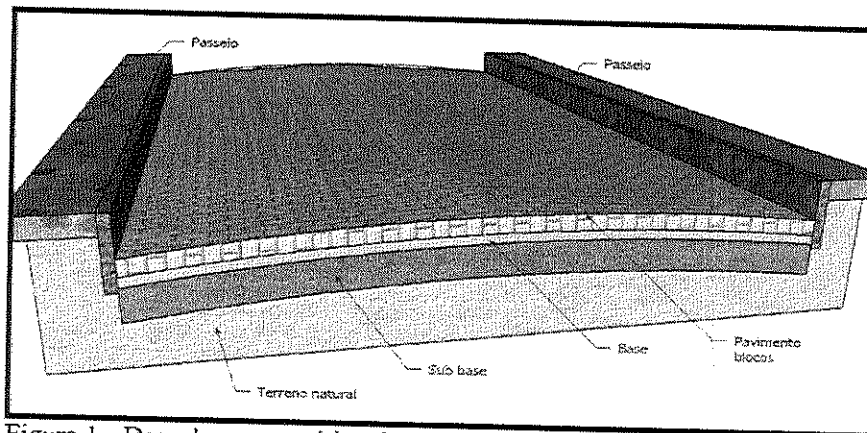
Desenho esquemático do perfil transversal da pavimentação
